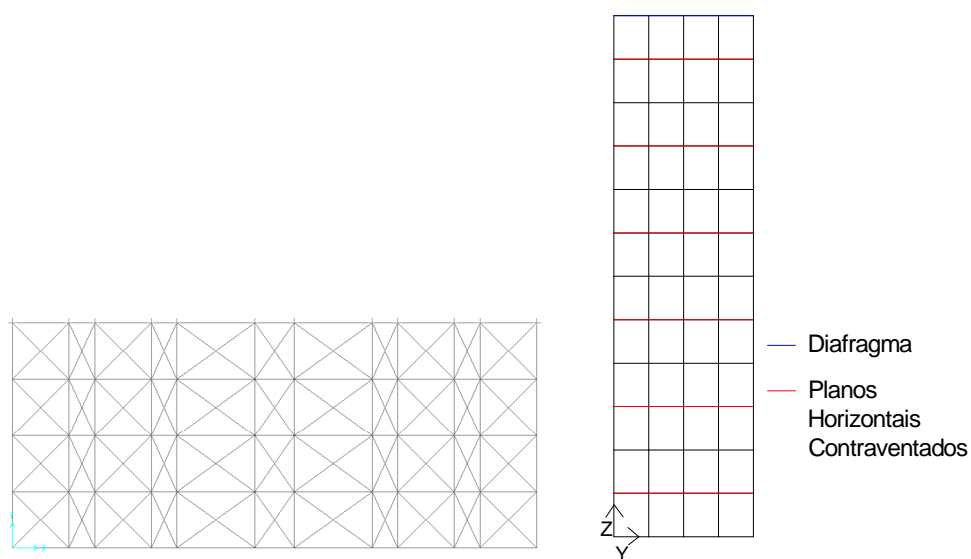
Configuração dos Planos de Contraventamento Horizontal Com Elementos de Contraventamento Pequenos
